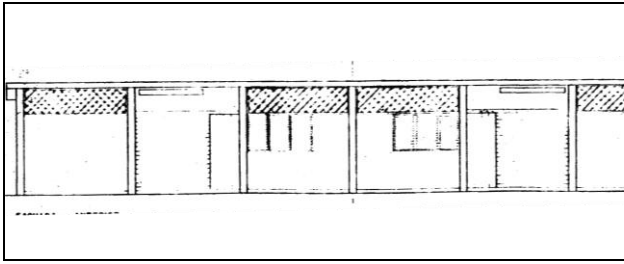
d. Vivienda SF-1. Fachada (1952)
